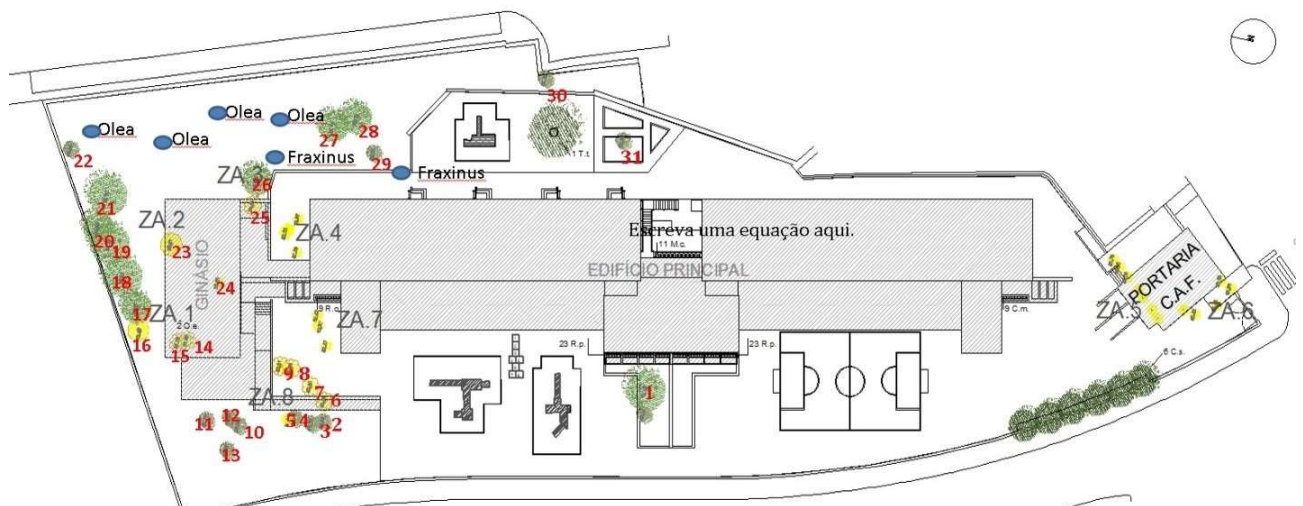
Planta do projeto de transplante de espécies arbóreas (s/ escala).
